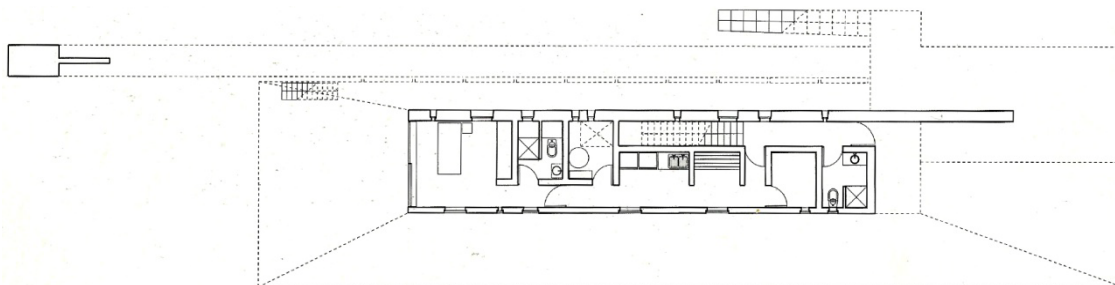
Planta baja. 2G Revista Internacional de Arquitectura
